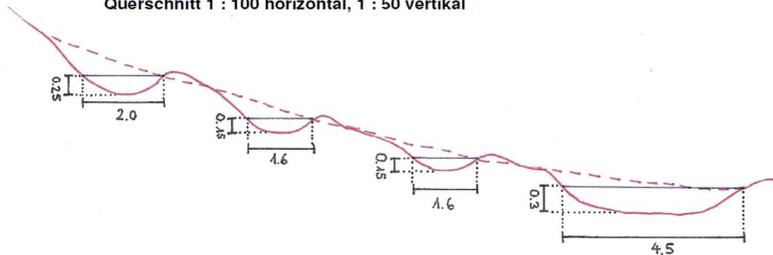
Plan Massnahme 3, (Planzeichnung: THOMAS HERTACH)
